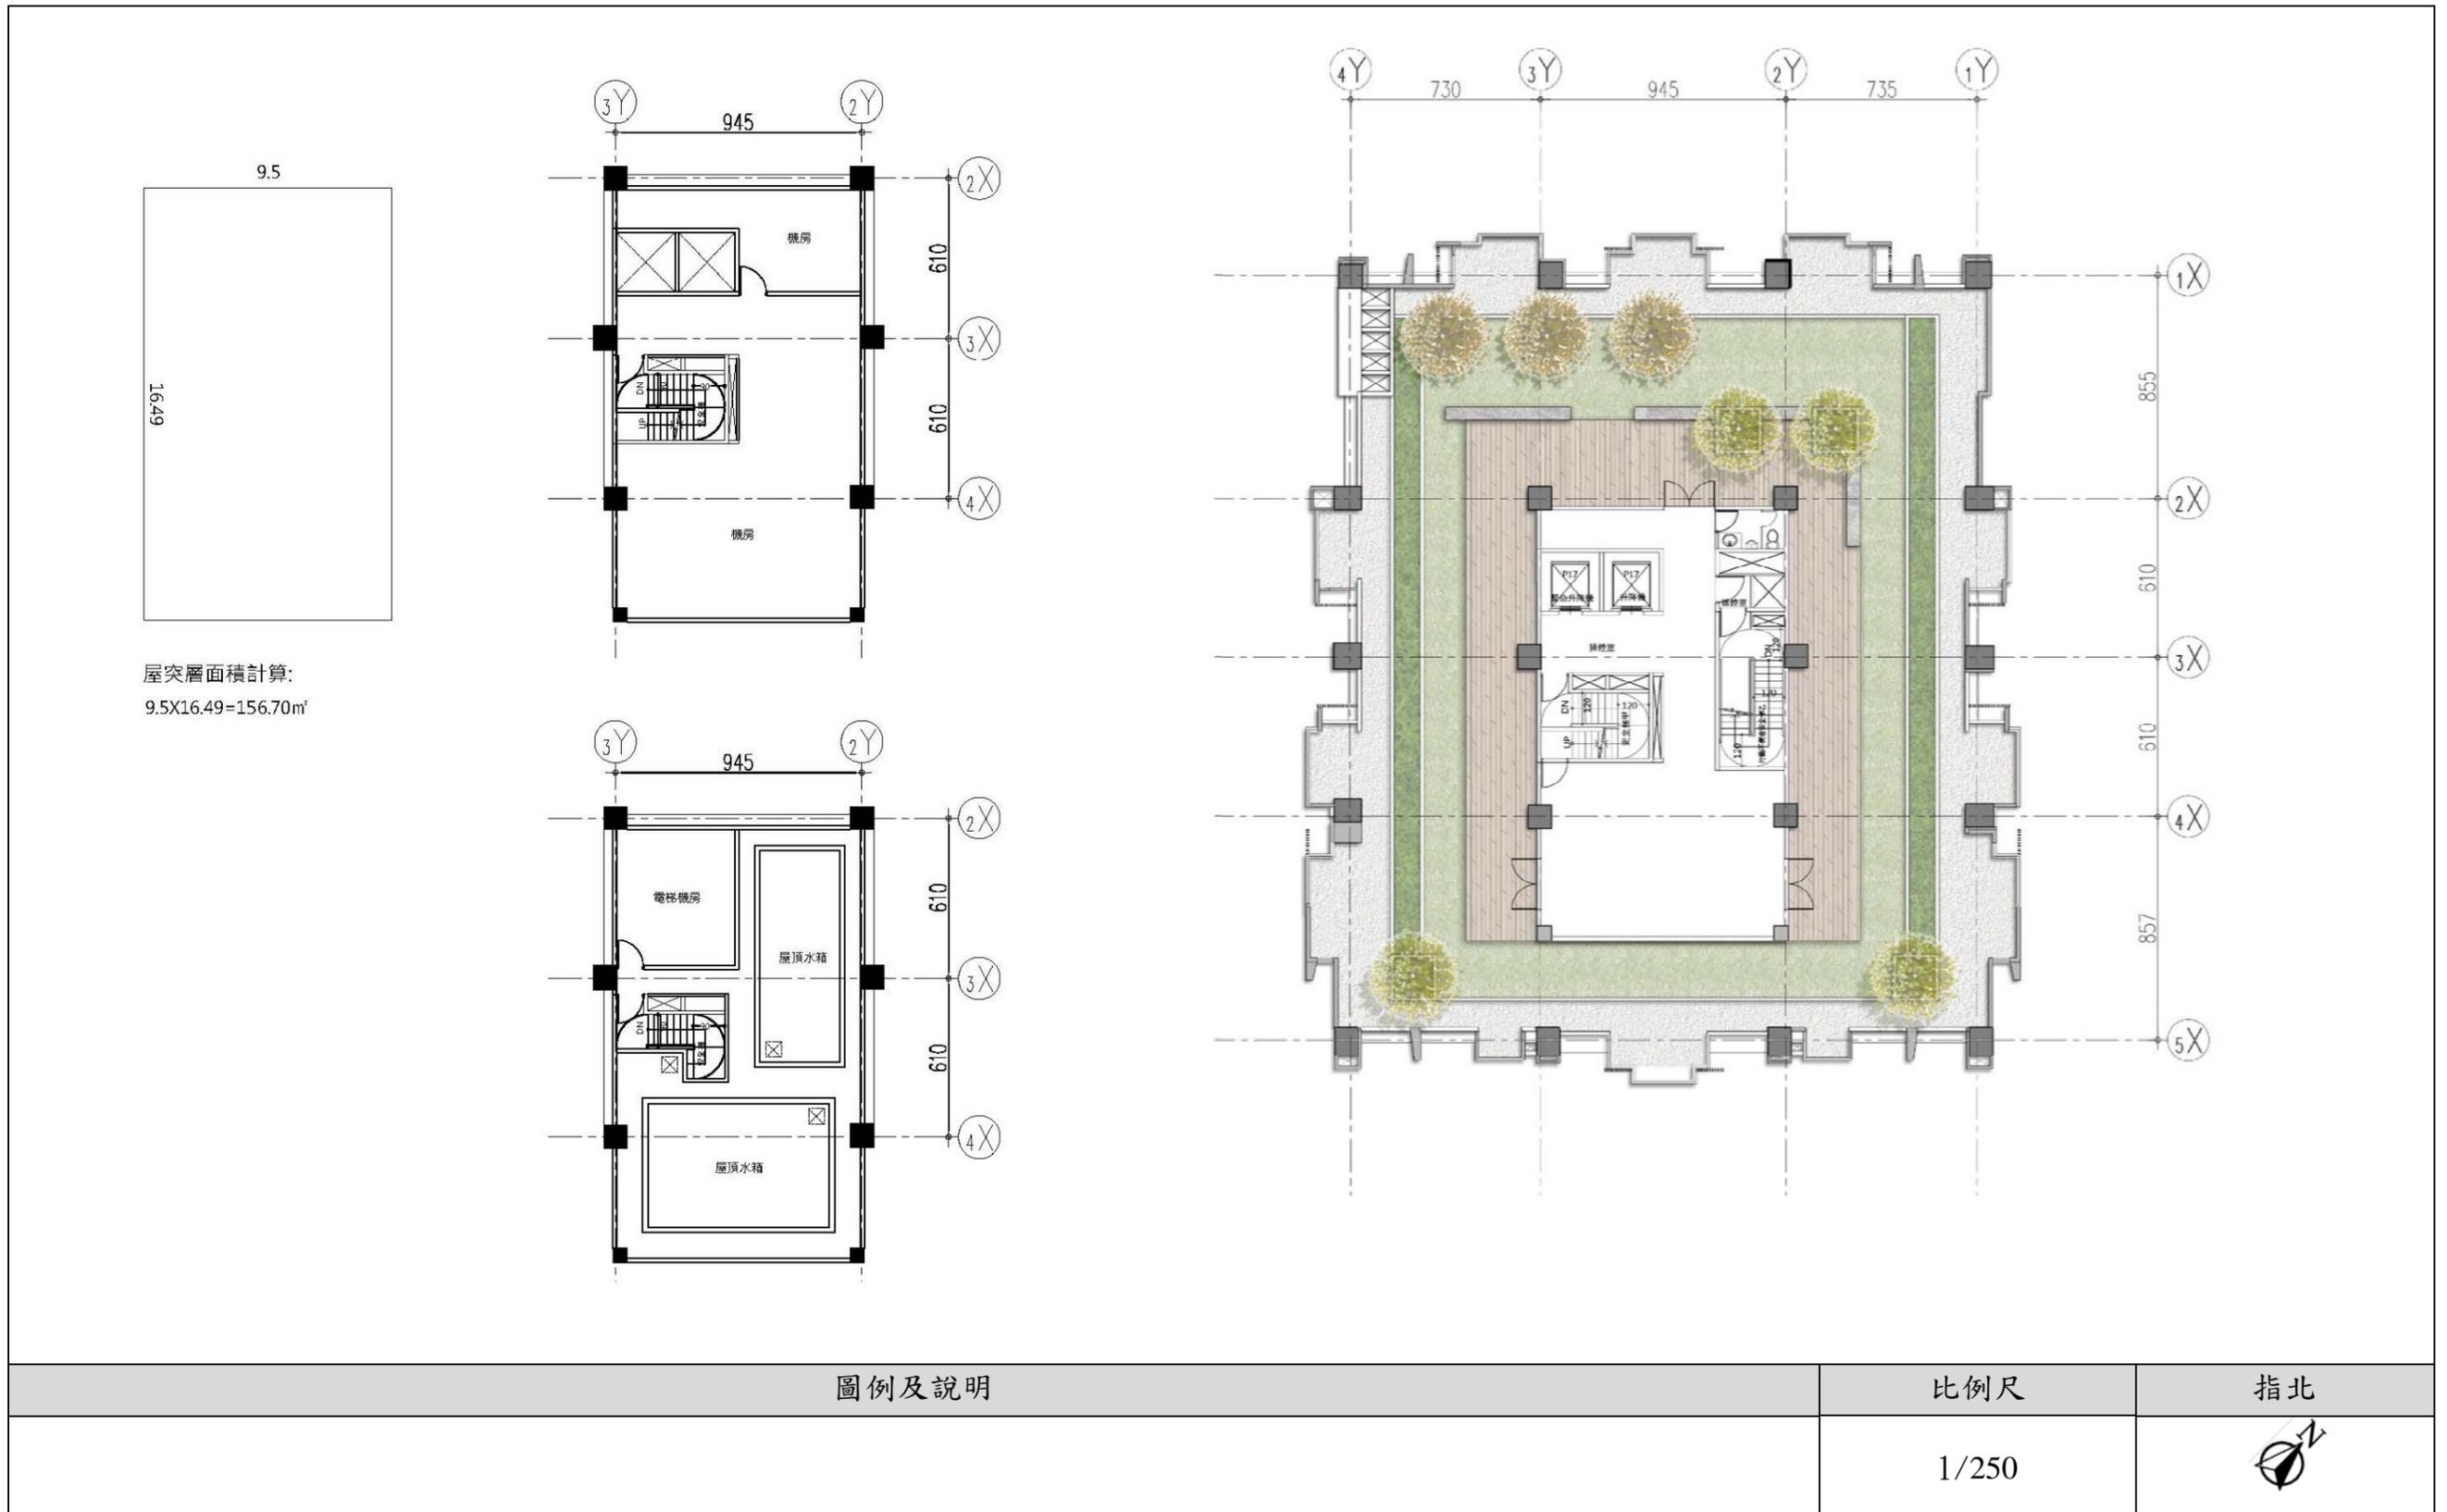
屋頂層及屋突一層平面圖及面積計算圖
